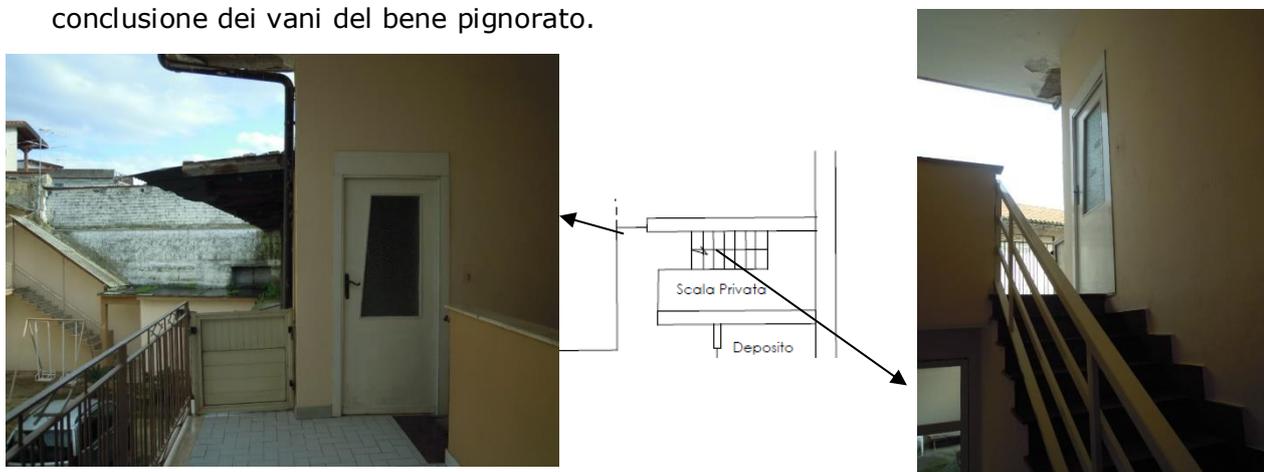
Individuazione fotografica del ballatoio e della scala del bene oggetto di pignoramento.
